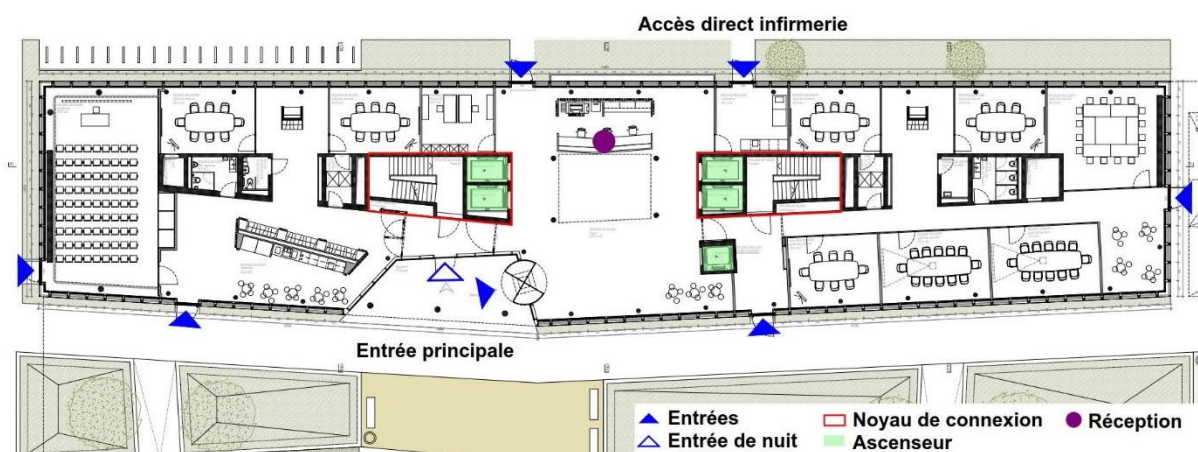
Bâtiment A2 - Plan du rez-de-chaussée
